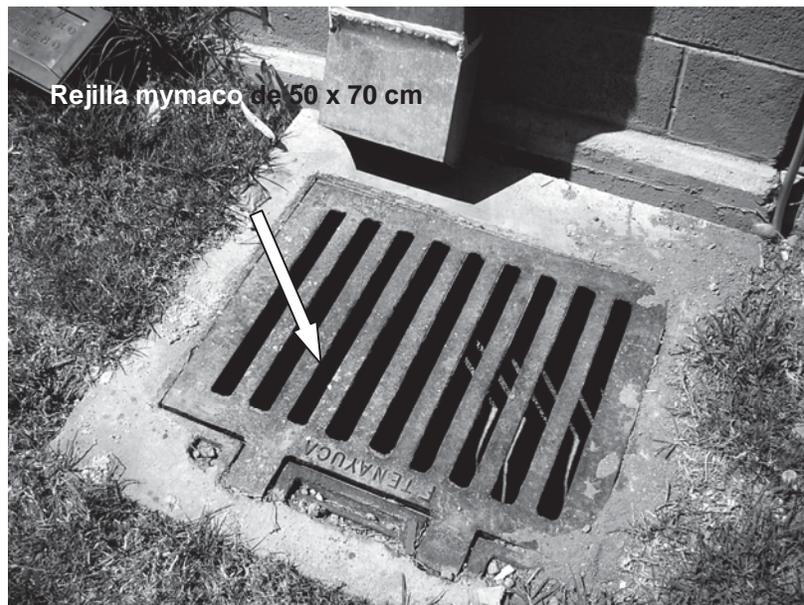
Registro pluvial con rejilla de piso.
